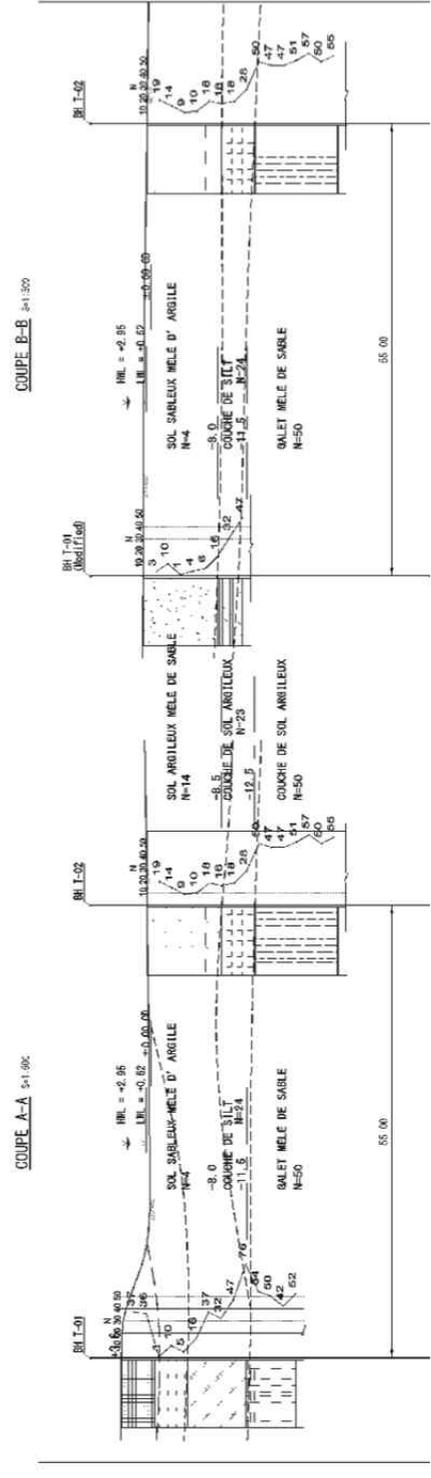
Plan d'estimation des sols du Port de Tadjourah
